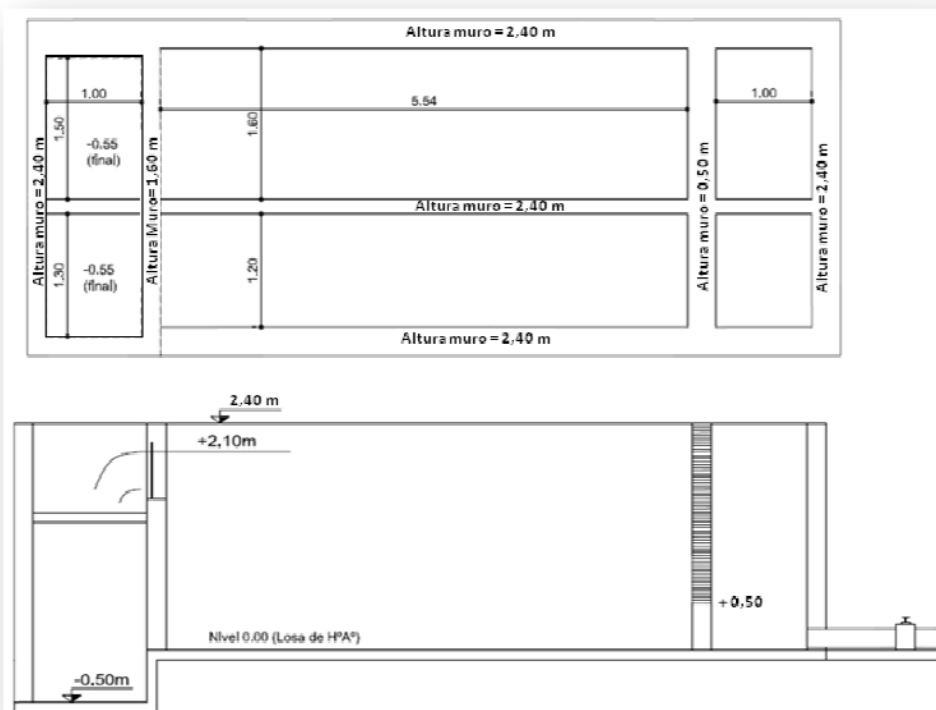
Corte y vista en planta de las cámaras de aforo del modelo físico.
